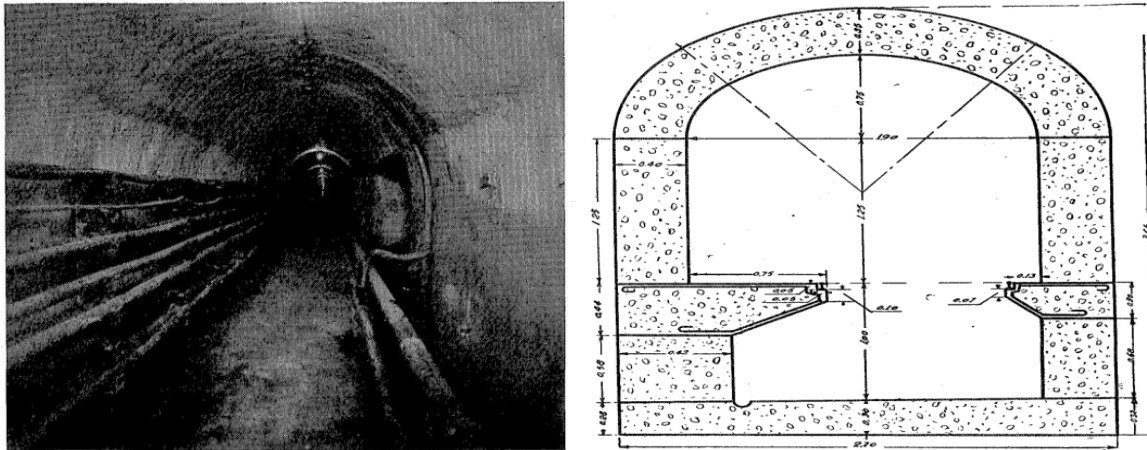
Alcantarilla de Bárbara de Braganza, en servicio y su sección tipo.
